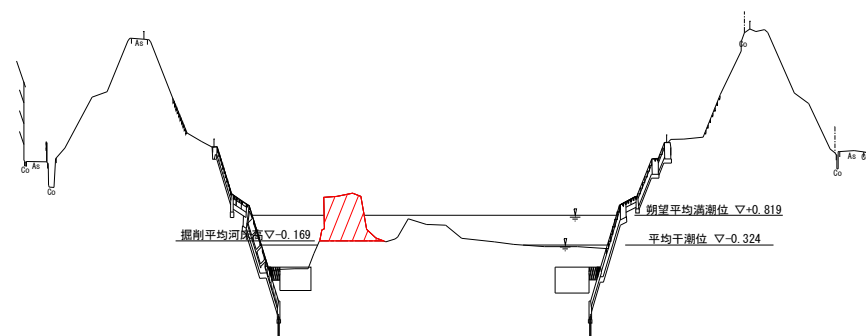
A-A断面図 (猪名川 2.2k 付近)
